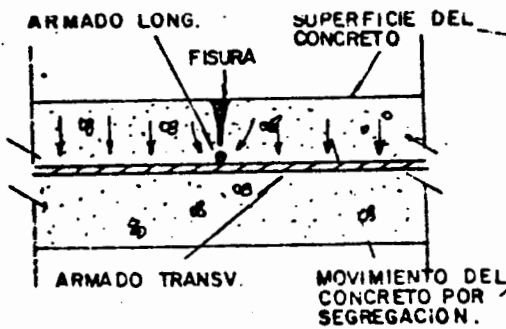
FISURAS EN EL CONCRETO A CAUSA
